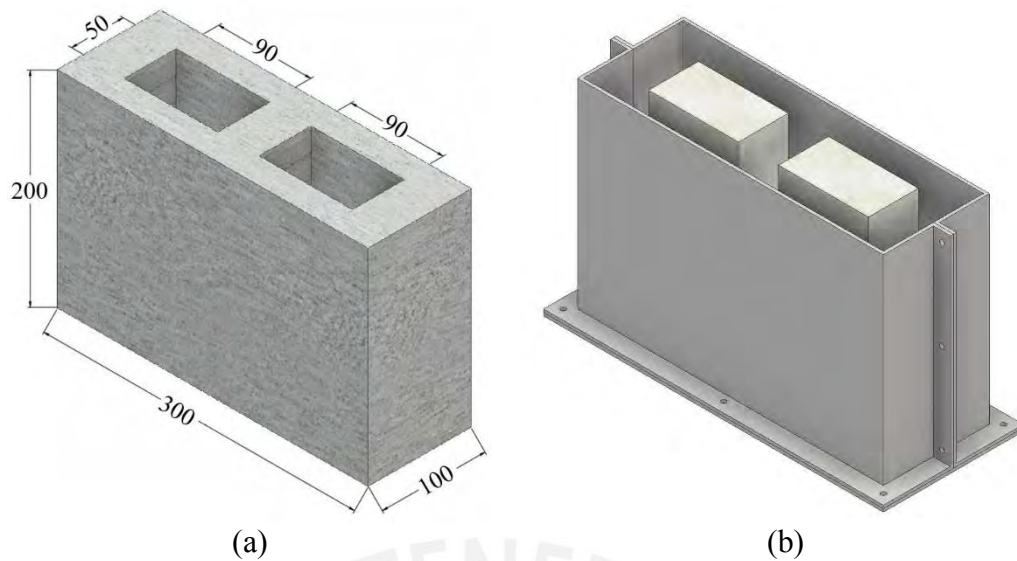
Dimensionado del bloque: (a) Características geométricas del bloque (Dimensiones en mm) y (b) molde metálico.
